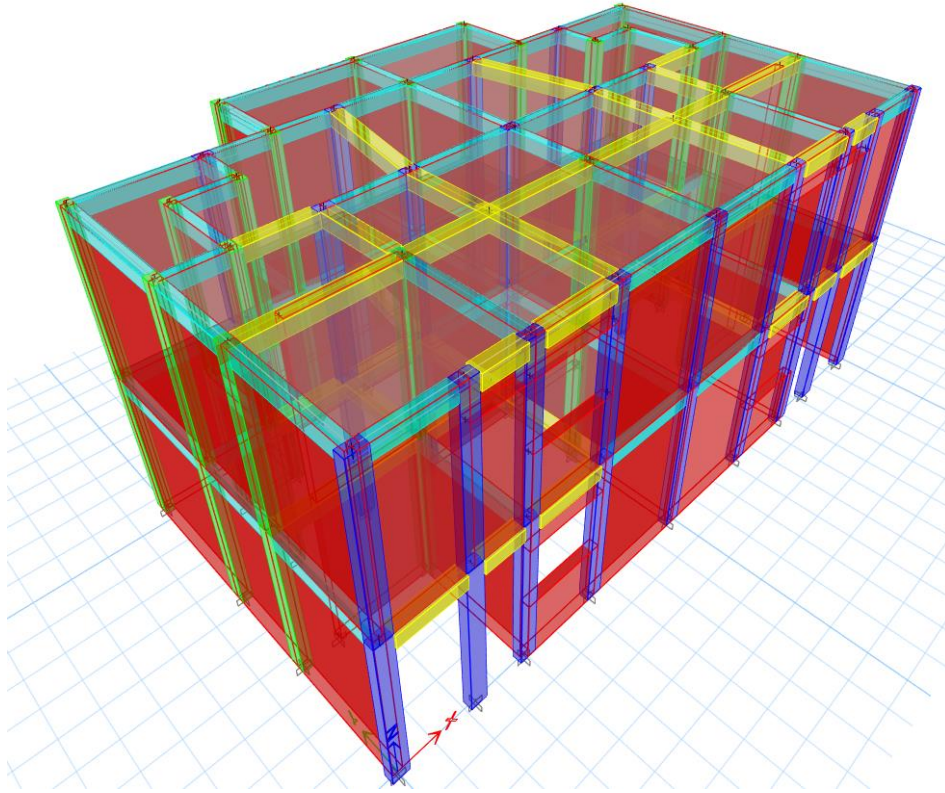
Vista general de la estructura de mampostería confinada. Fuente: Propia
